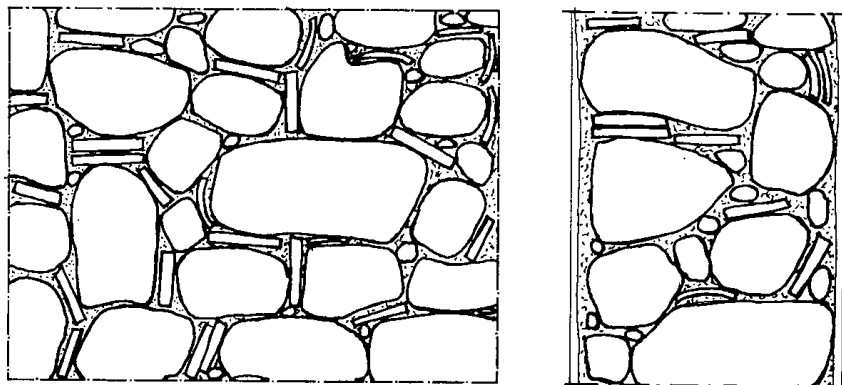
Muratura a tessitura irregolare (Randazzo 1988).
